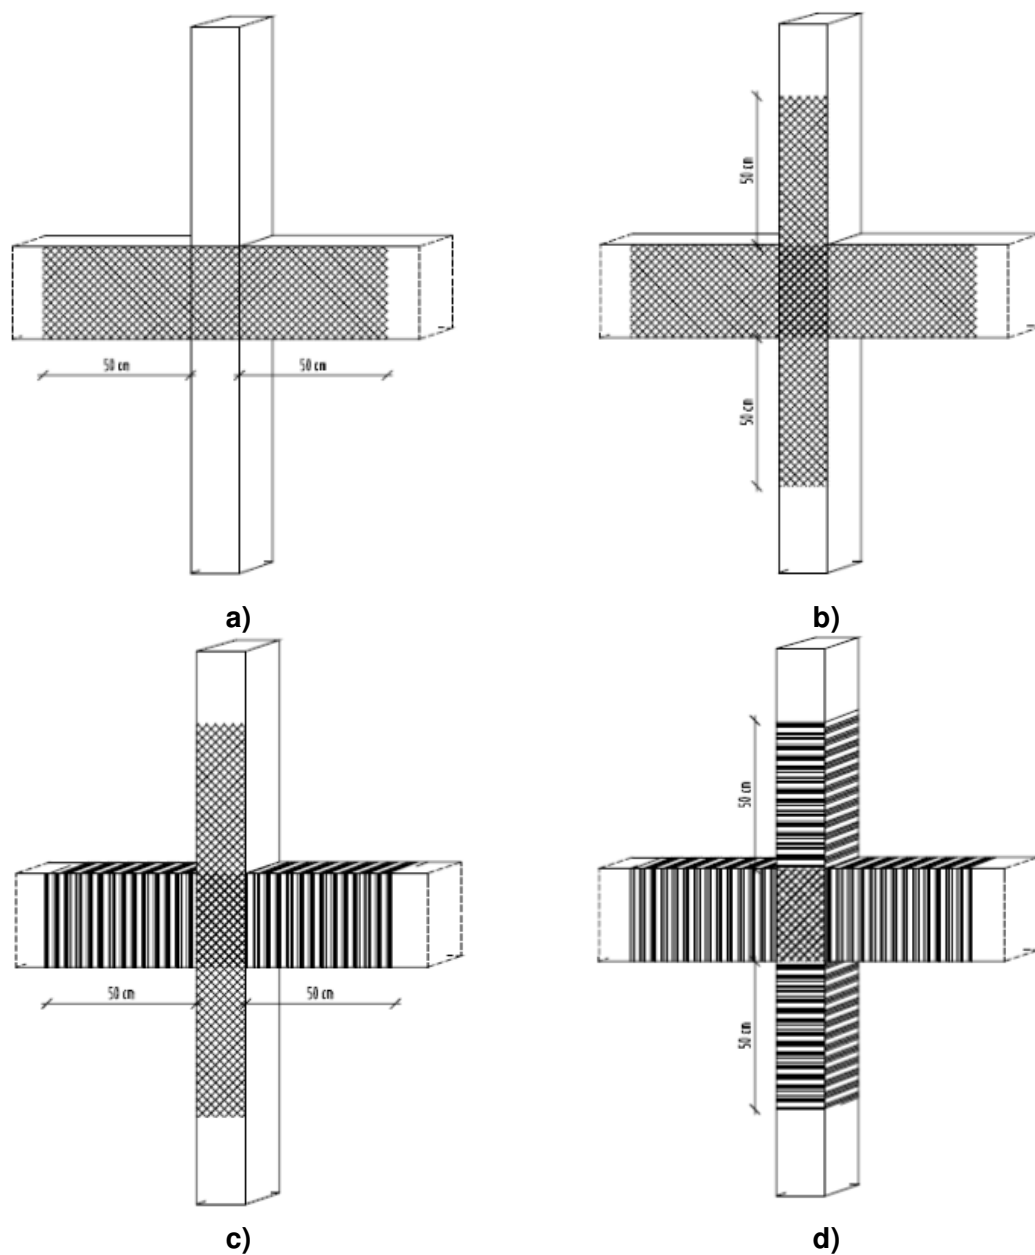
Secuencia de aplicación de fibras en un nudo viga columna: a) y b) Aplicación de tejido cuadriaxial en el nudo, vigas y columnas; c) Reforzamiento de vigas con fibras unidireccionales; d) Confinamiento de columnas con fibras unidireccionales.
